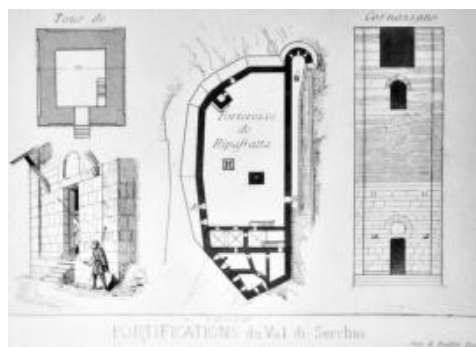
De Fleury, 1873, Tav. XLIX, Plan général - Coupe - Plan détaillé - Torre di Cornazzano
